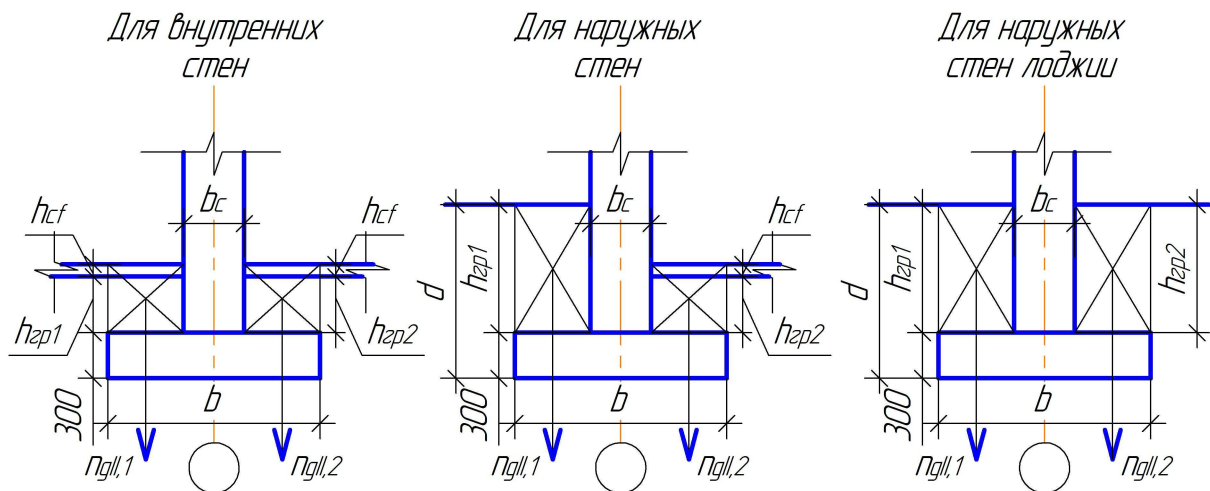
Схемы к определению веса грунта и пола на уступах фундаментной плиты
